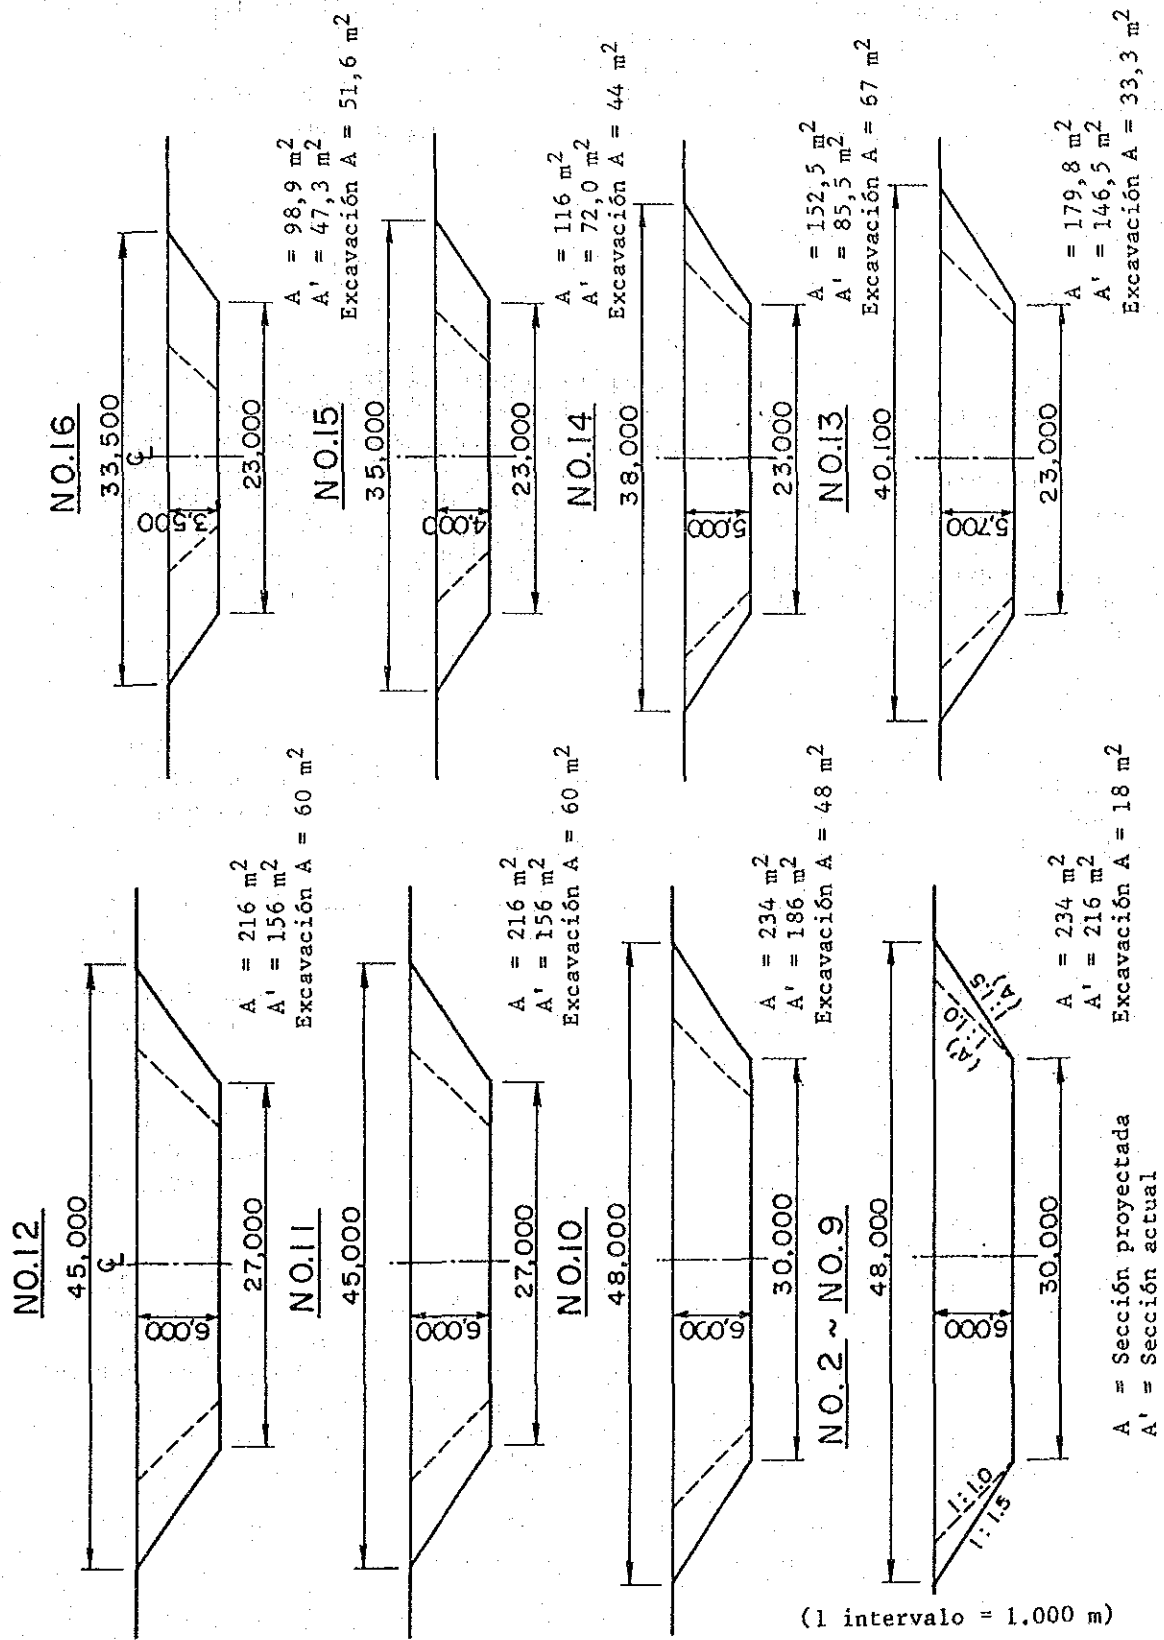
PLANO DE SECCION MODIFICADA DEL ARROYO TACUARY
